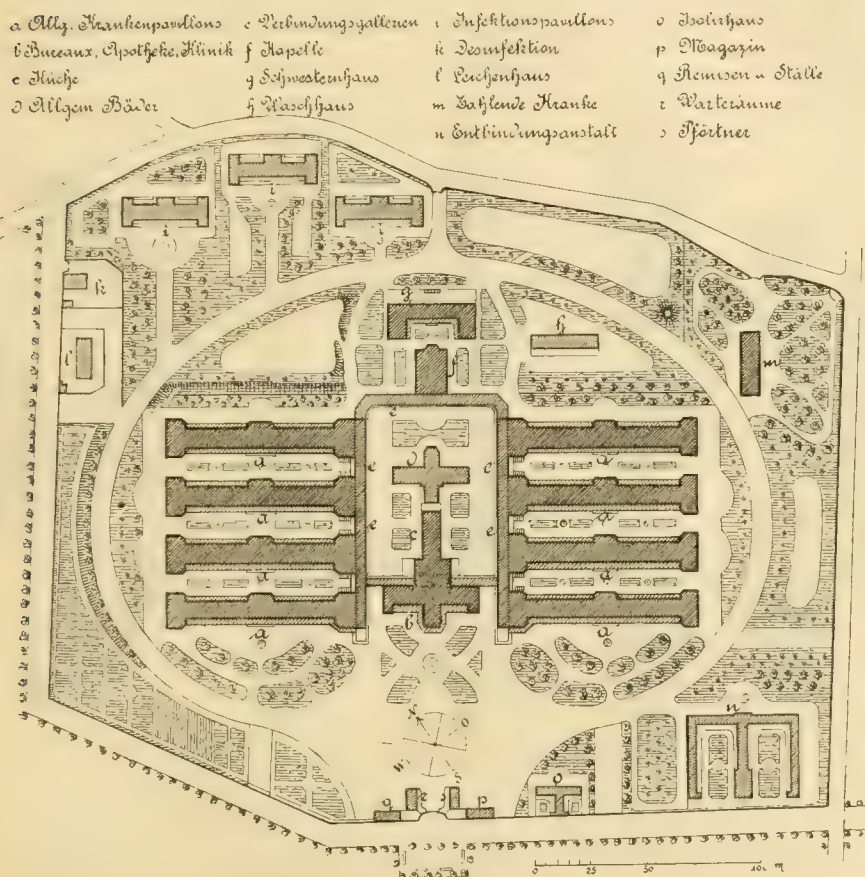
Civil- und Militär-Hospital in Montpellier. Lageplan.
